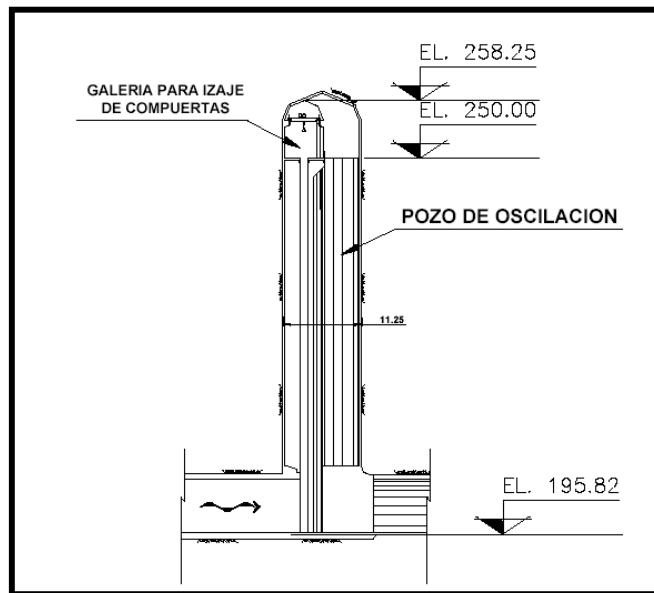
Corte longitudinal de la galería para izaje de compuertas y pozos de oscilación
